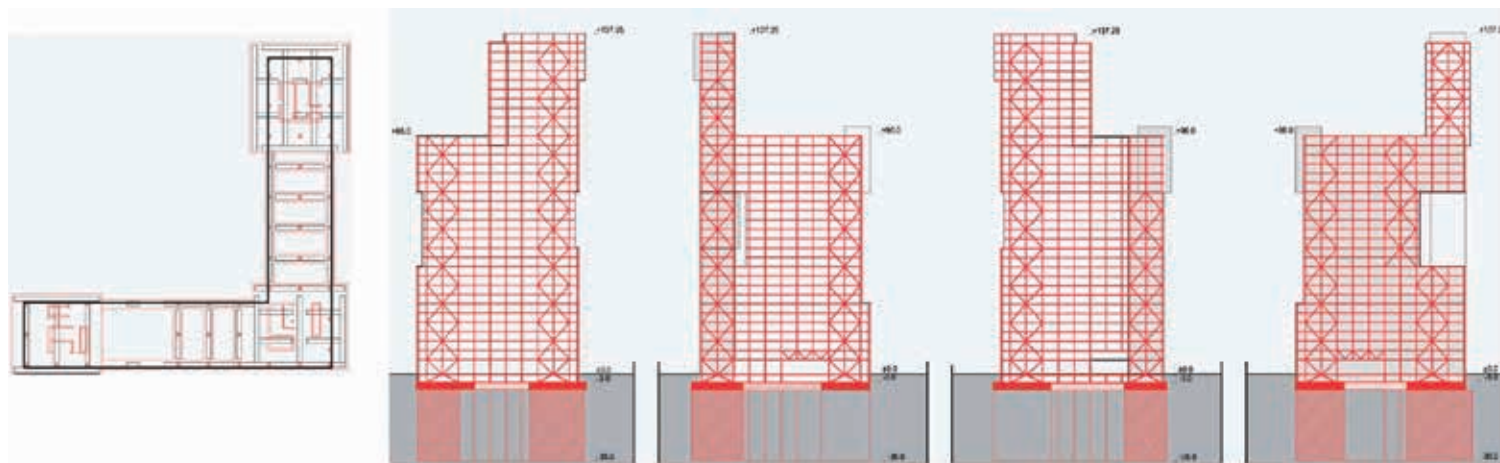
| Edificio Zip Padova – Pianta e schema controventature
